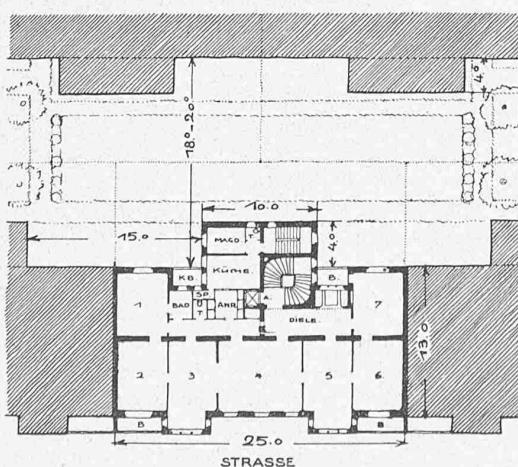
Grundriss-Typ, 1:600 (in Abb. 7 kreuzweise schraffiert).
